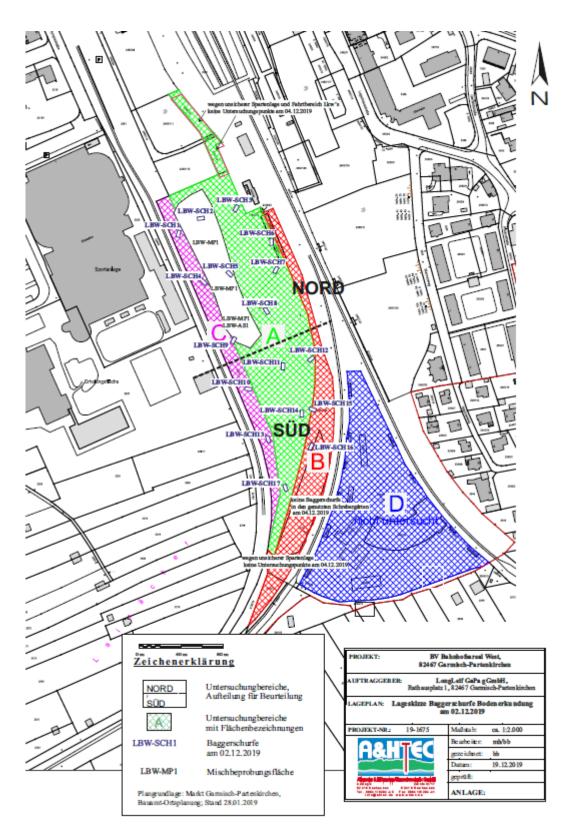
Übersichtsplan mit Untersuchungsbereiche – Auszug Bericht Orientierende Bodenuntersuchungen" vom 14.01.2020; (Ingenieurbüro A&HTEC Albrecht & Hörmann Umwelttechnik GmbH), Darstellung unmaßstäblich
